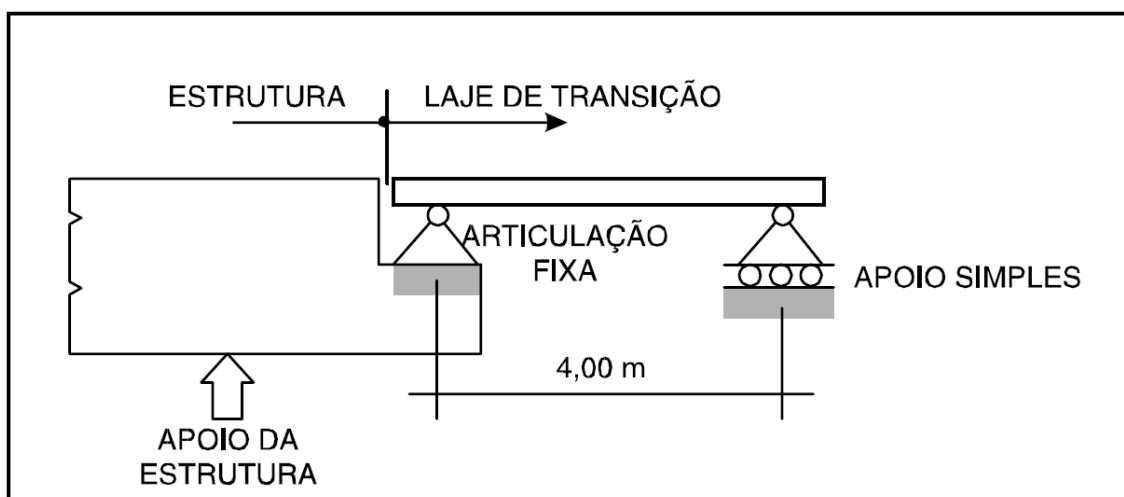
Esquema estrutural simplificado para cálculo da laje (DNER,1996)
